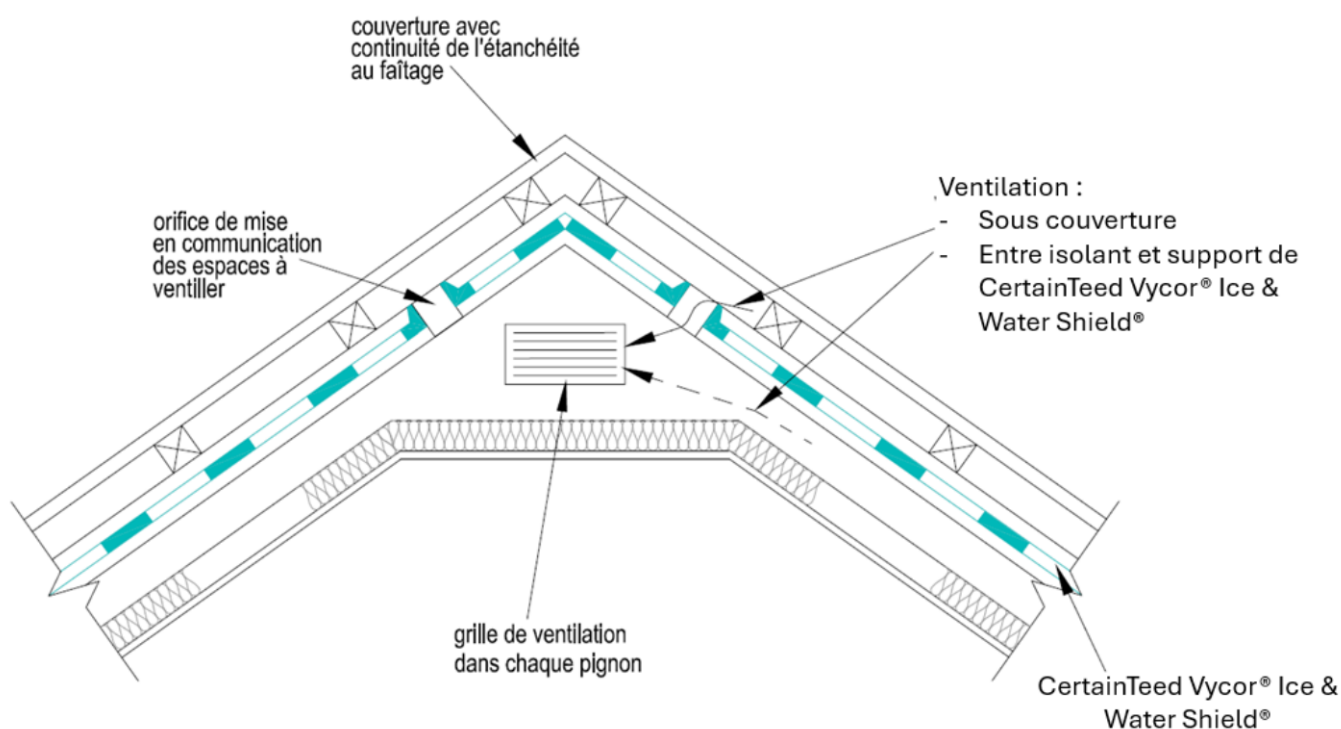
Faîtage avec ventilation par grilles en pignons (distance entre pignons \leq 12 m)
